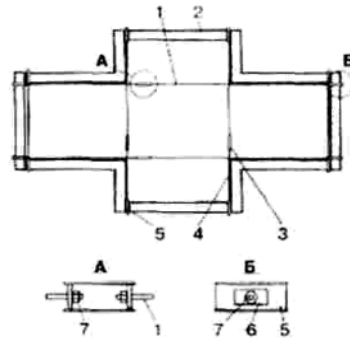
Схема підсилення будівлі об'ємним обжиманням: 1 - поздовжні тяжі; 2 - стіни будівлі; 3 - натяжні муфти; 4 - поперечні тяжі; 5 - швелер; 6 - металева підкладка; 7 - гайка
